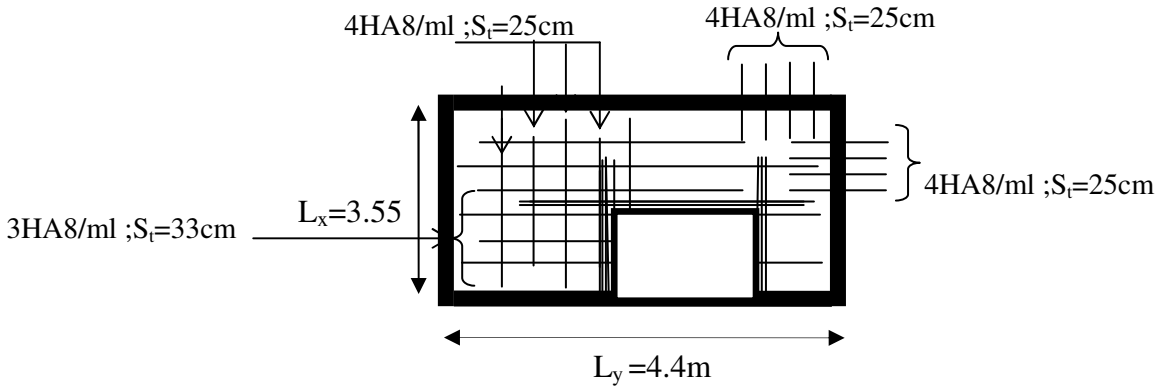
Schéma de ferrailage de la dalle pleine sur quatre appuis
